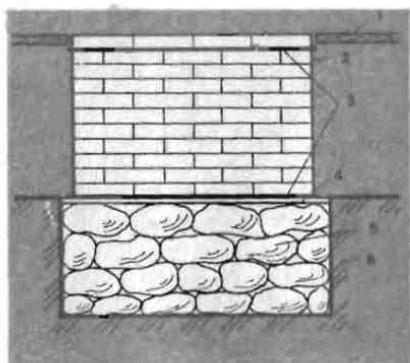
Сплошной фундамент из бутового камня и кирпичной кладки
